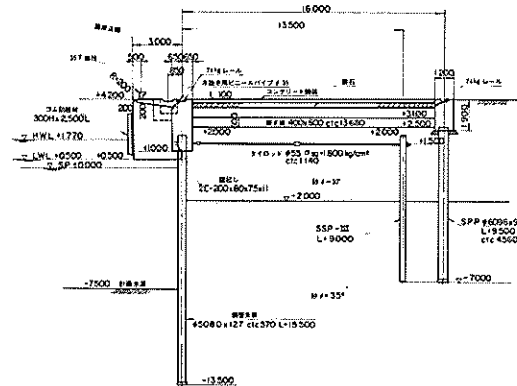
仙台港吾端製鋼岸壁(-7.5m)標準断面図
